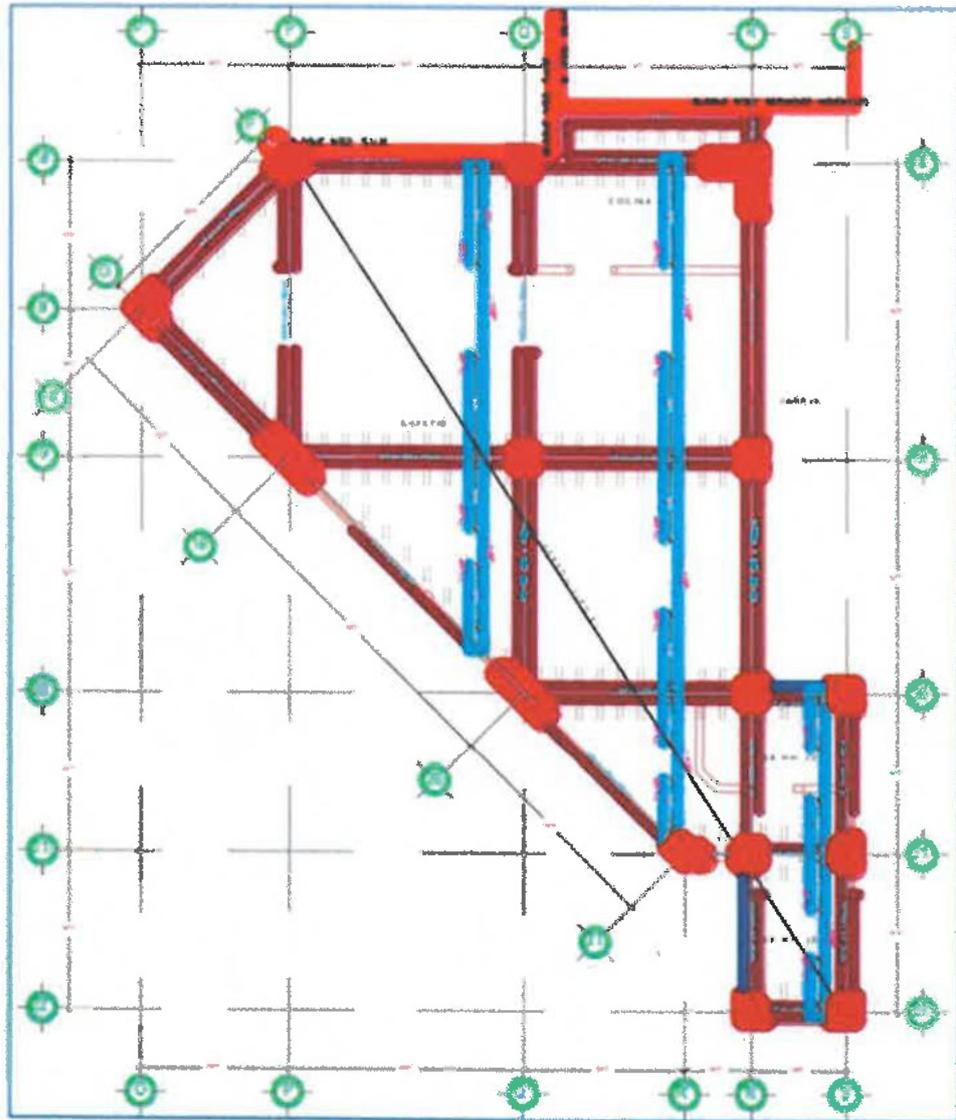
Plano estructural típico 2º nivel de vigas y aligerados.
